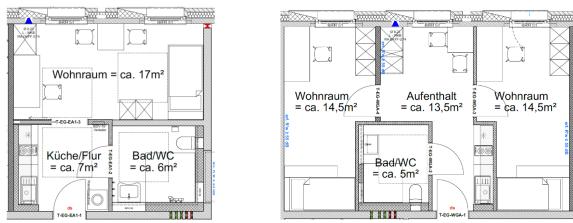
Grundrisse Ein-Zimmer- und Zwei-Zimmer-Apartments © Schmidt Architekten BDA
